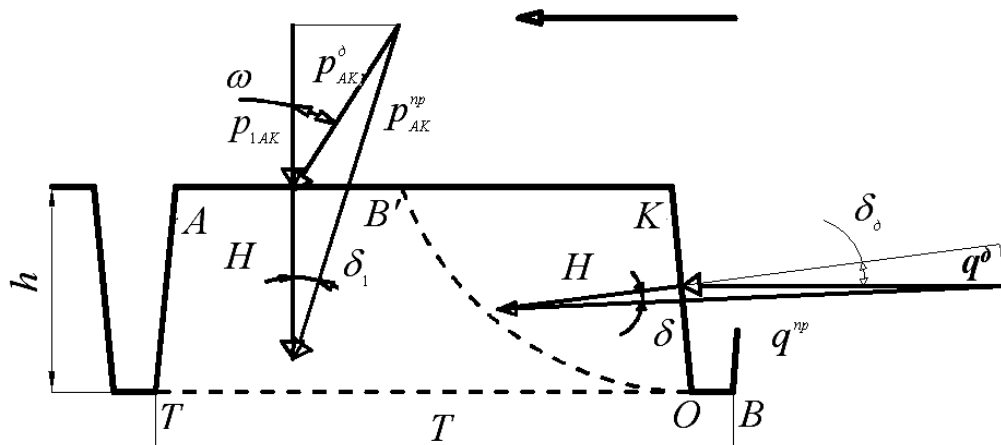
Расчетная схема начальной фазы разрушения грунта
